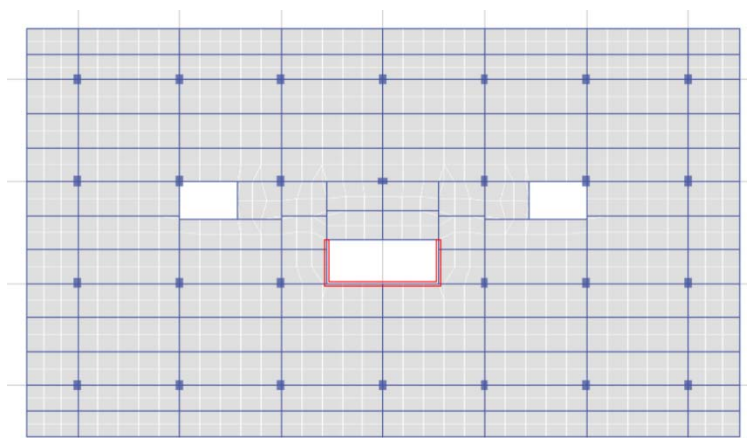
Planta modelo No. 2, luces de 7 metros en dirección x.
